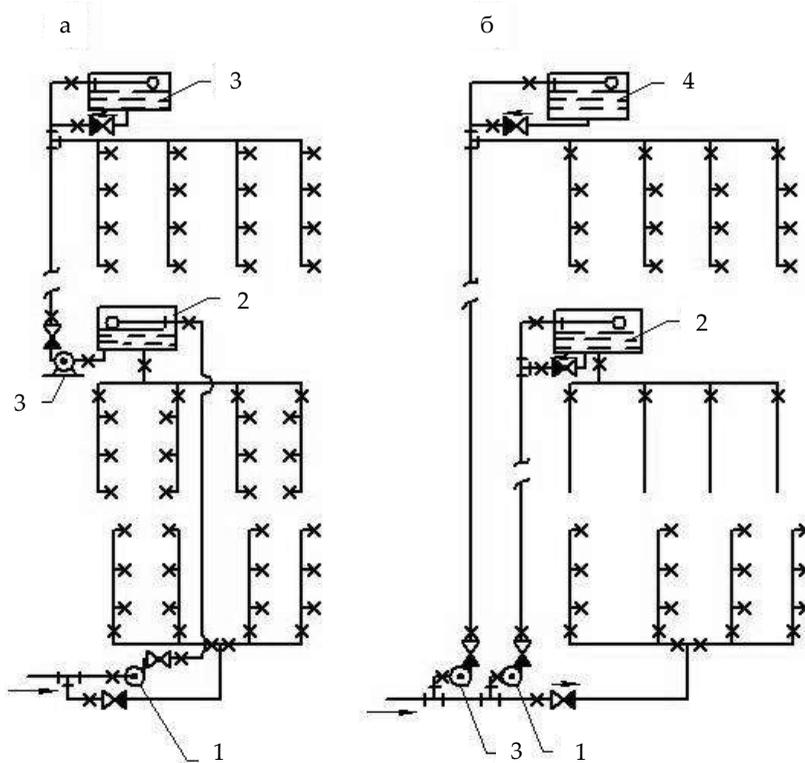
Последовательная (а) и параллельная (б) схемы зонных водопроводов зданий:
